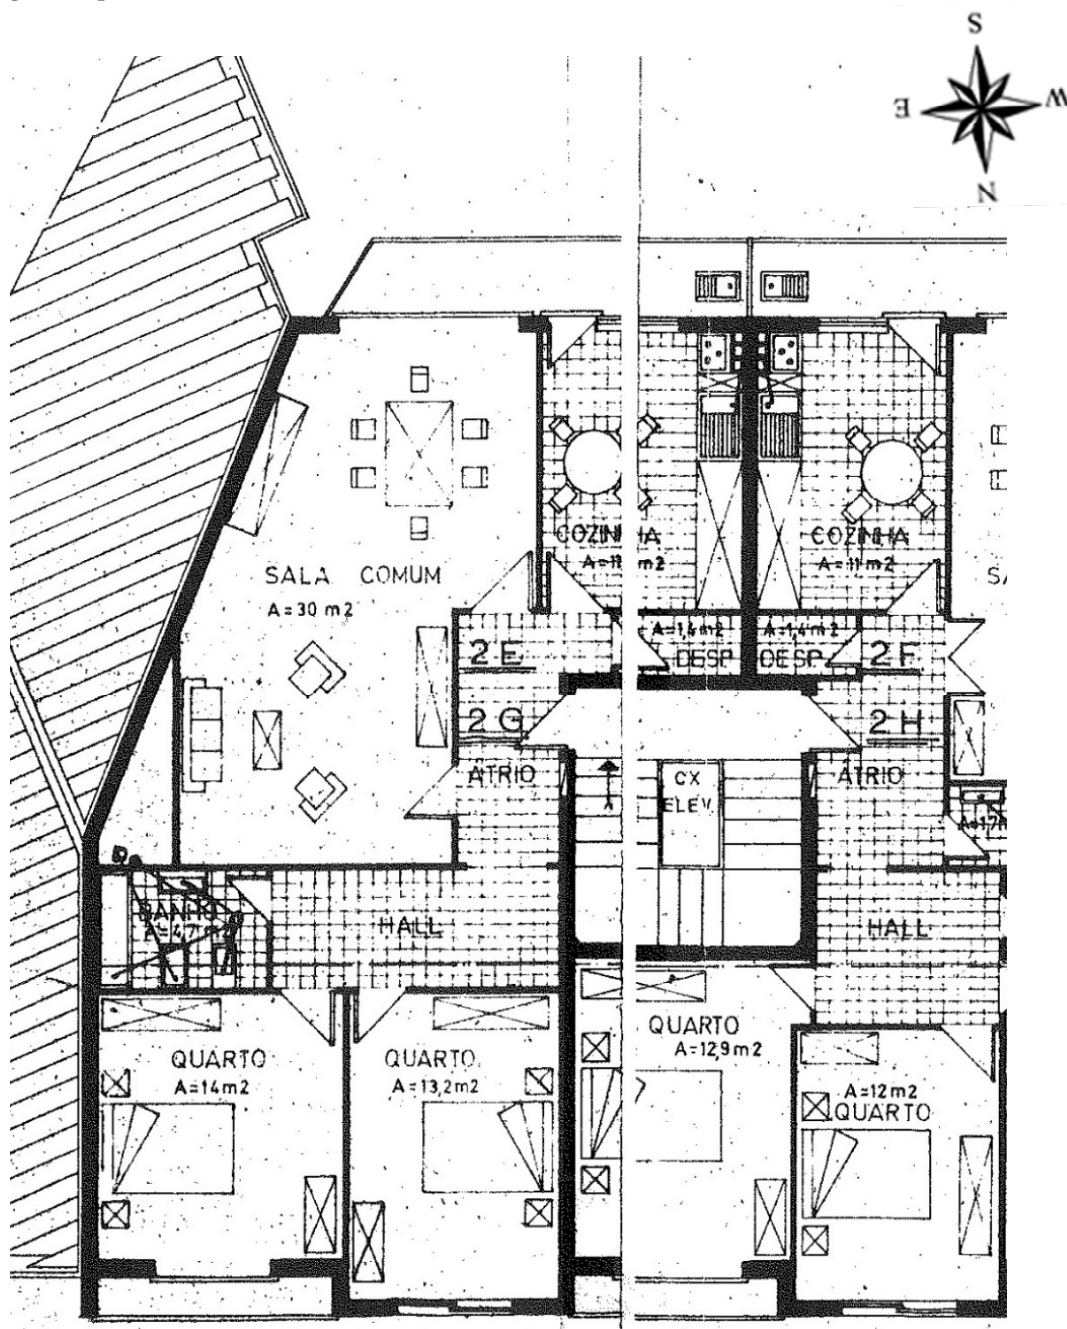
Planta da FA do projeto de arquitetura sem escala
